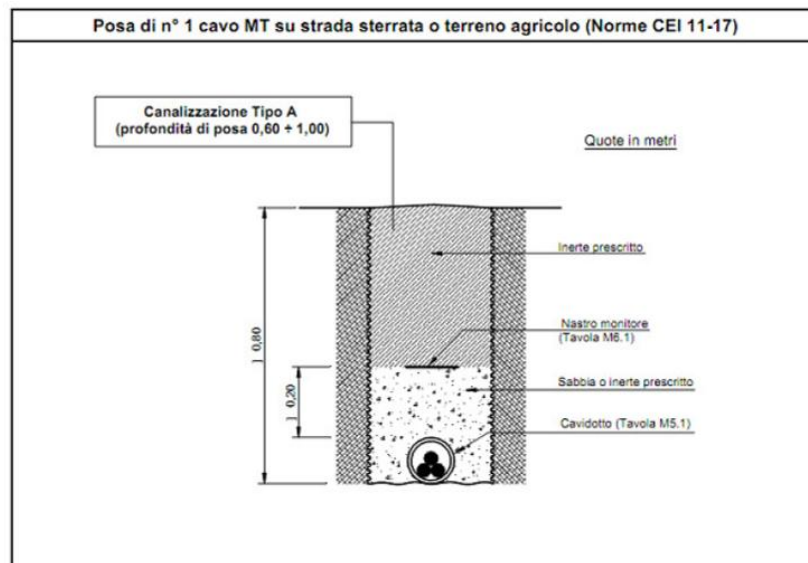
Sezione Tipica di Posizione della Linea in Cavo su Terreno Agricolo
